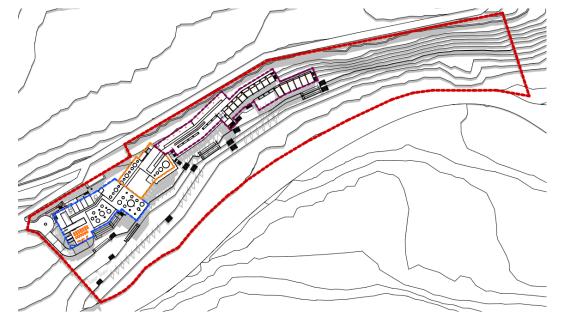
Plano de sectorización. Fuente: Elaboración propia.
